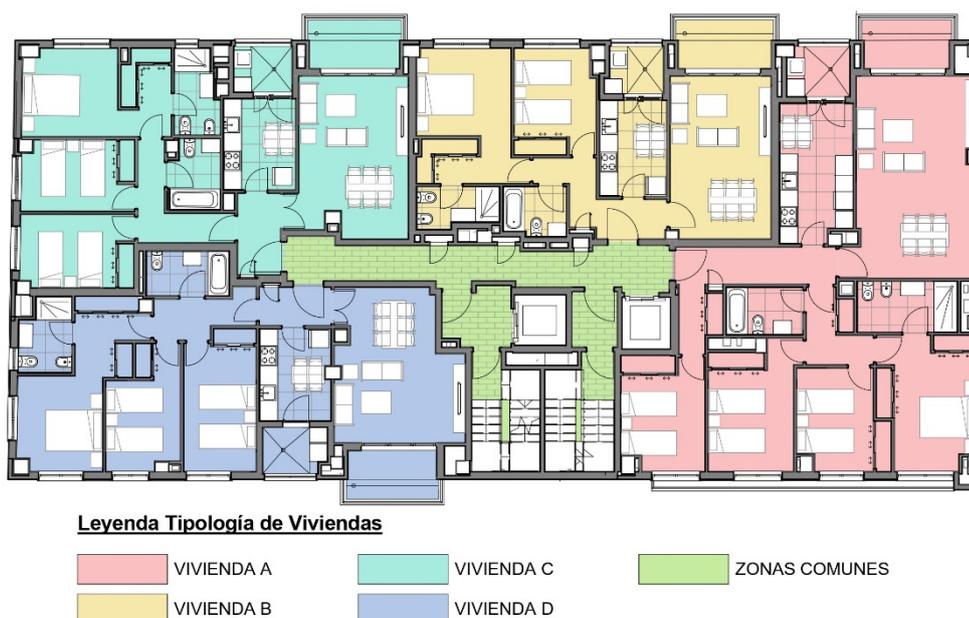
Plano indicativo de tipología de viviendas. Elaborado por la autora
